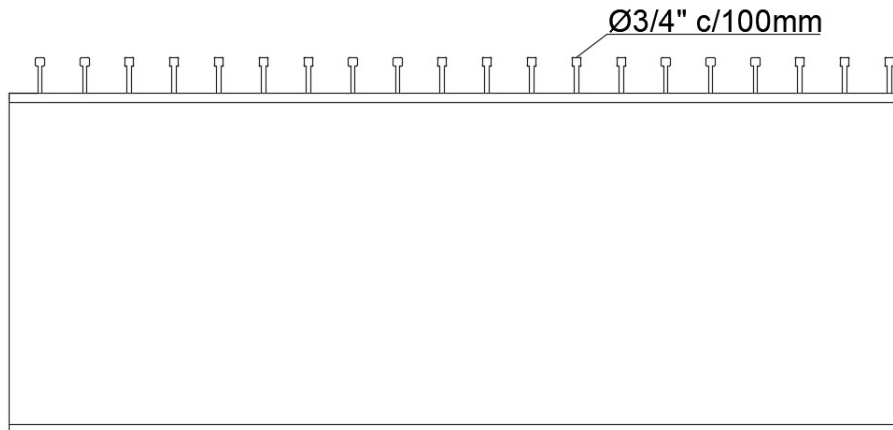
Vista lateral de la viga longitudinal central con los conectores de corte en el ala superior.
